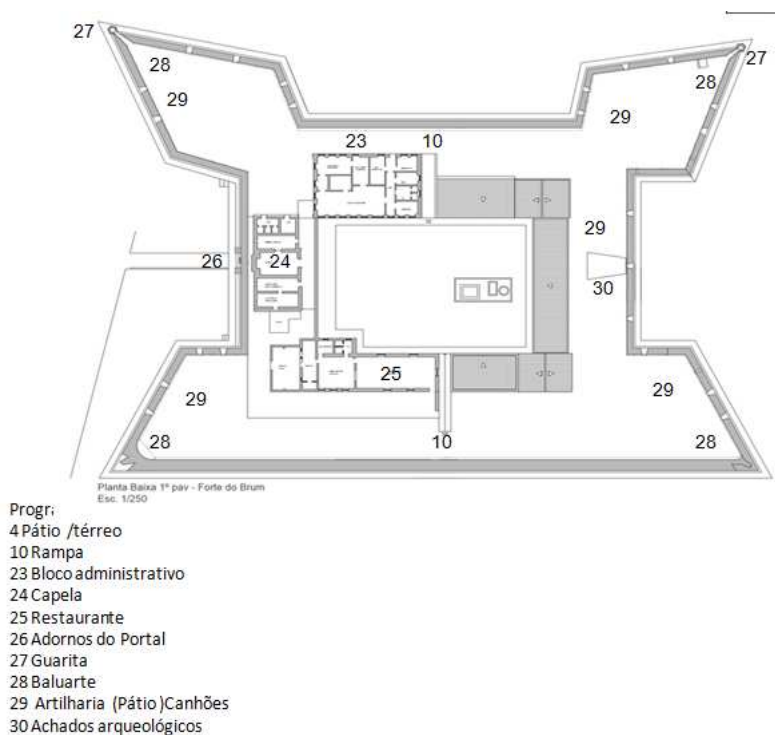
Usos do 1º pavimento- terraplano do Forte do Brum
